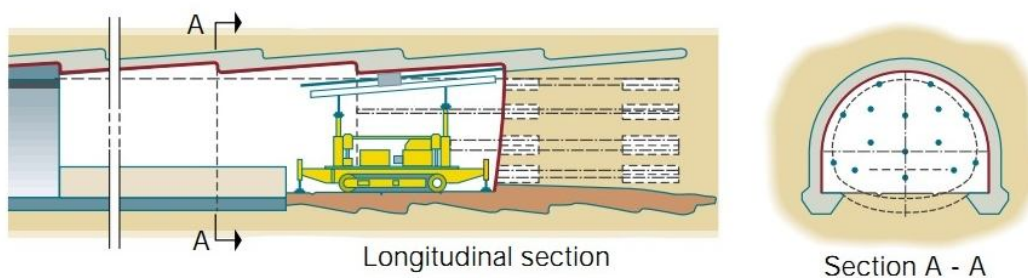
Aplicação de colunas sub-horizontais de *jet-grouting* na abóbada e núcleo de um túnel [36]
